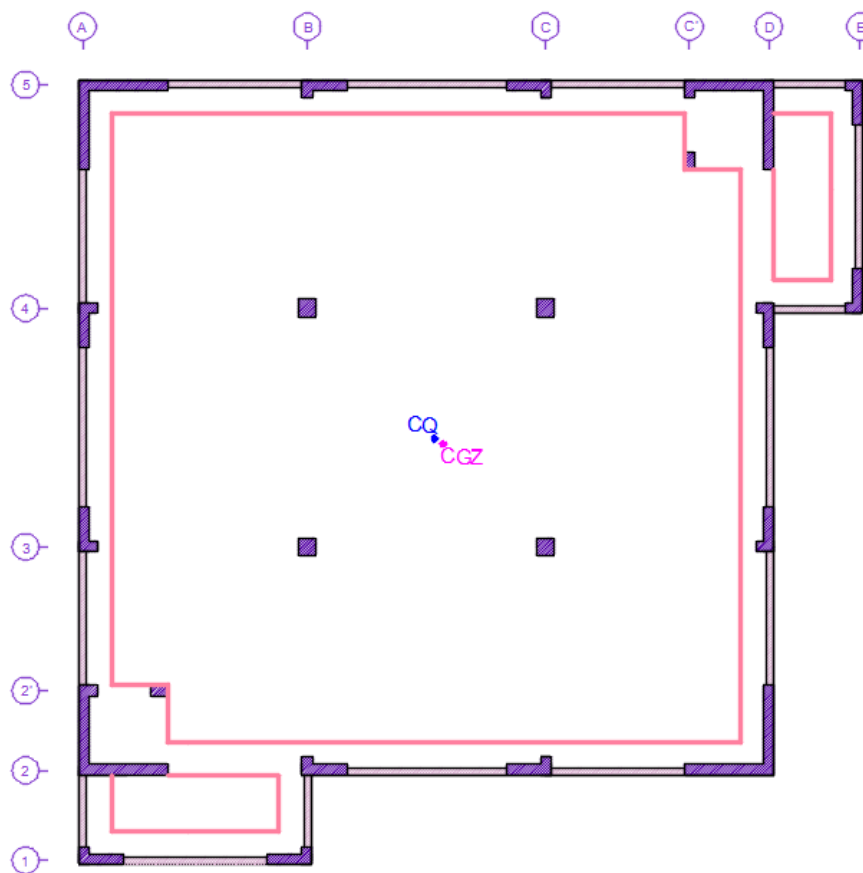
Centro de gravedad de la cimentación y centro de aplicación de las cargas
